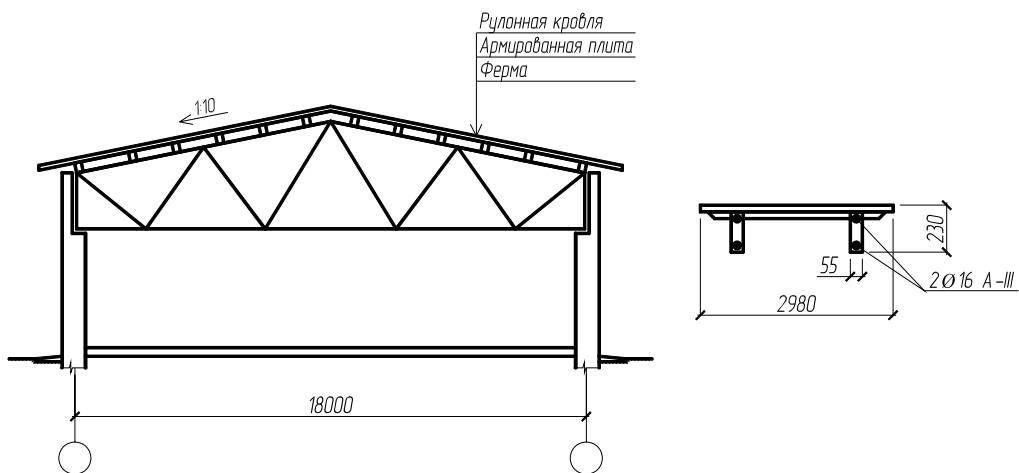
Армированные деревянные плиты размерами 3х6м в покрытии склада химудобрений (Беларусь)
